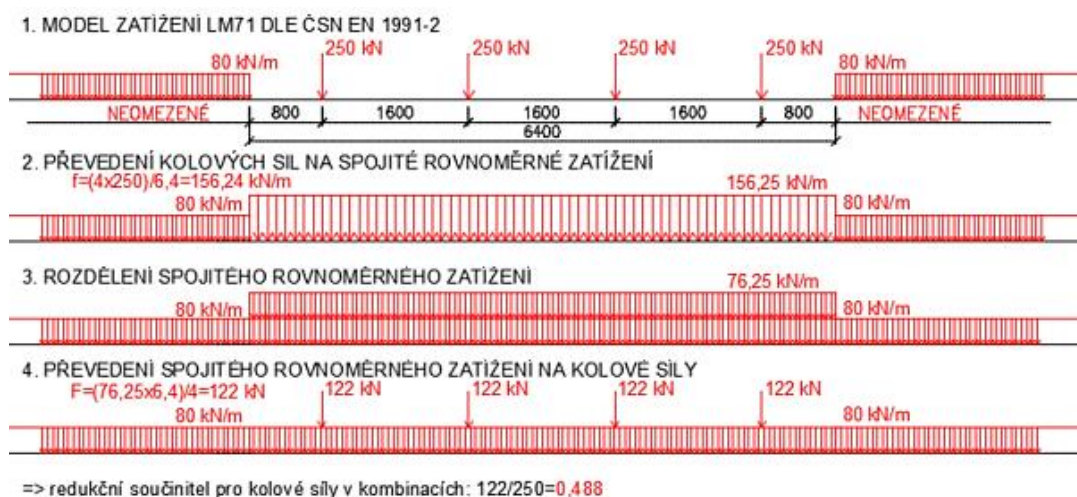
Schéma umístění kolových sil modelu LM71– varianta 3
